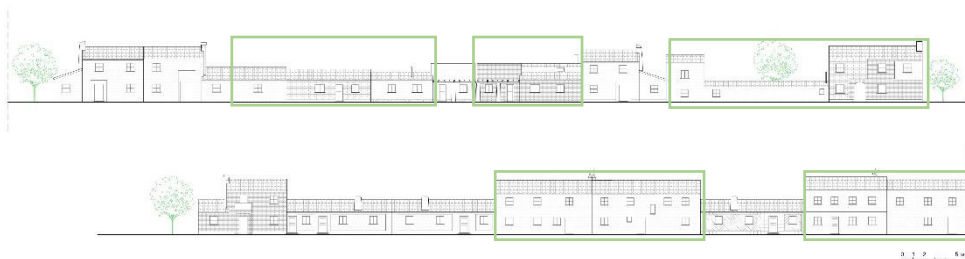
Sección longitudinal actual C/Mayor de El Temple con viviendas restauradas señaladas. Fuente: Elaboración propia.
